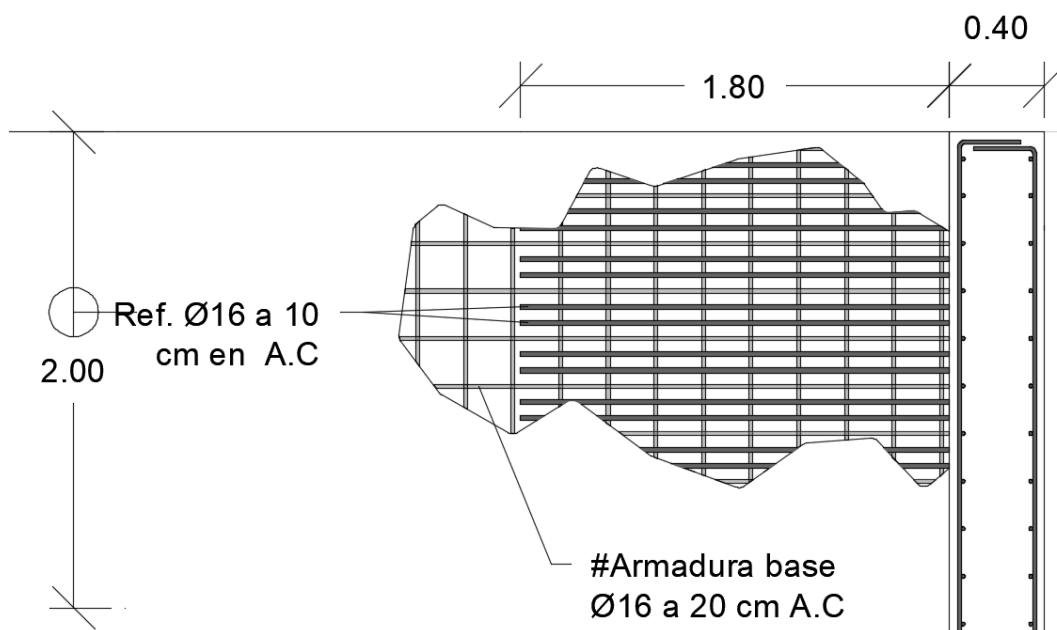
Refuerzo en muro interno 3 central (armadura horizontal)
